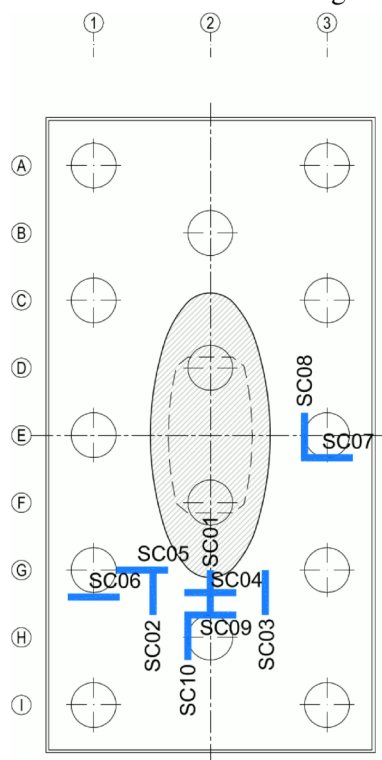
Localizzazione planimetrica delle sezioni di verifica prese in esame.
